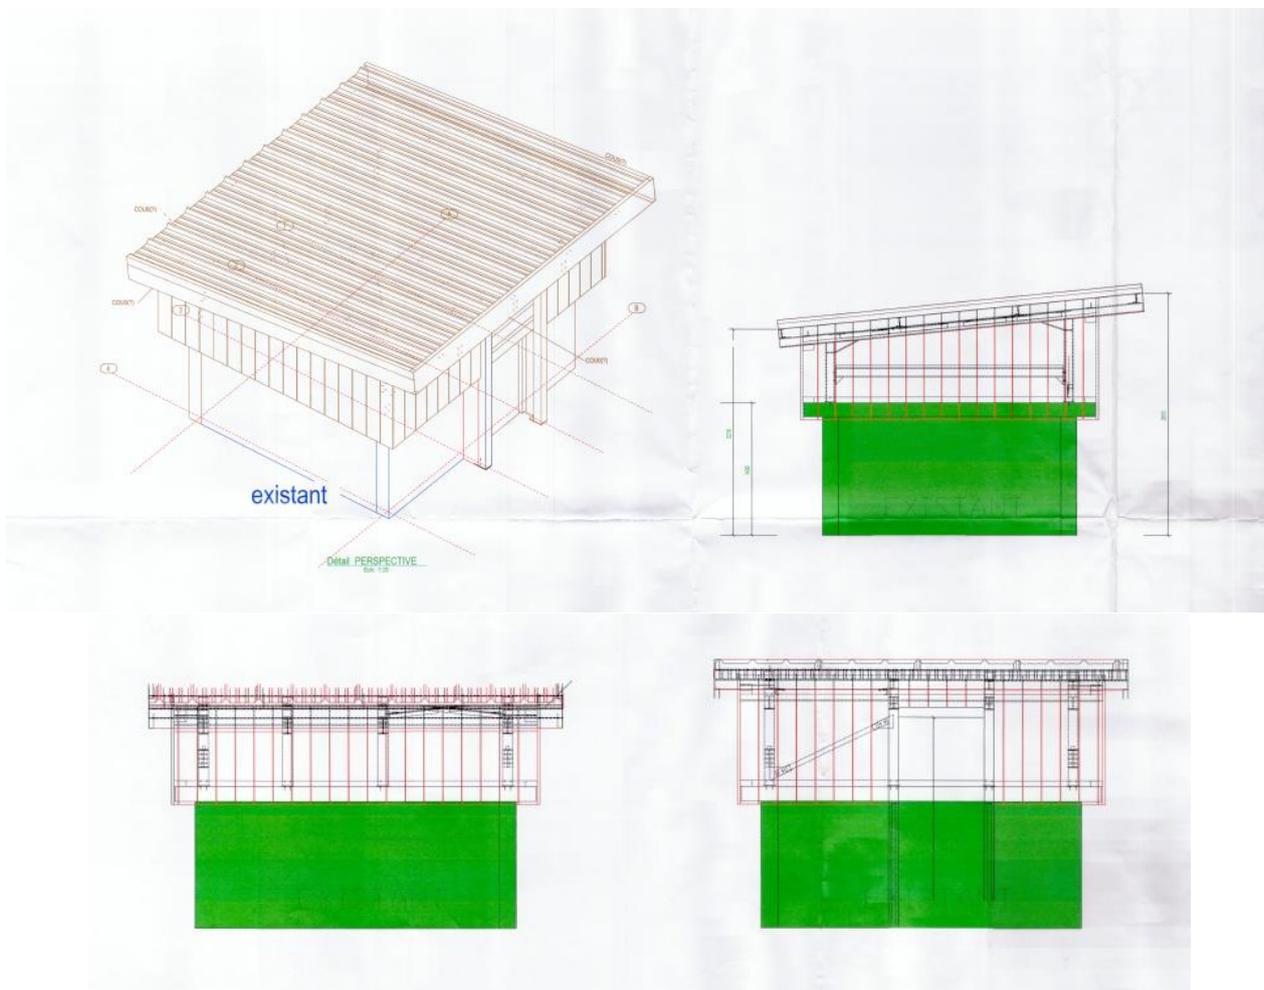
Vues d'ensemble du local technique actuel, en vert, et de la réhausse.
